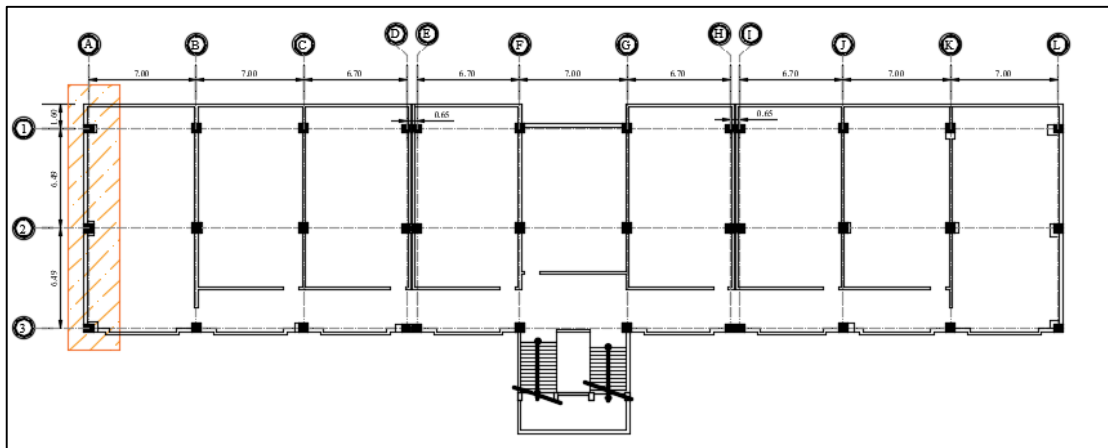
Planta arquitectónica tipo y selección del caso de estudio.
